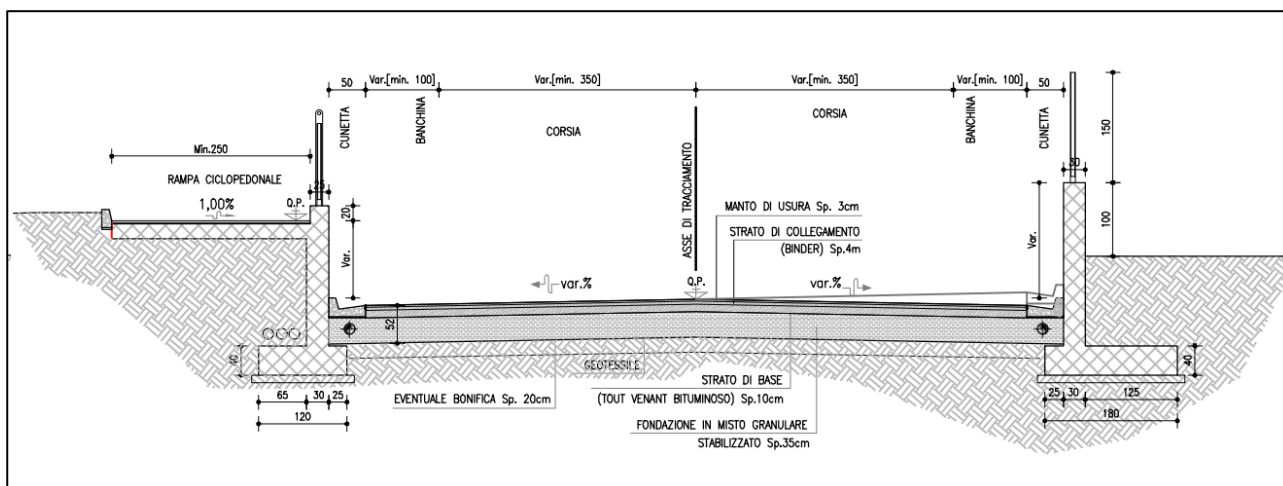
Sezione tipo asse principale con pista ciclopedonale e muro di contenimento
